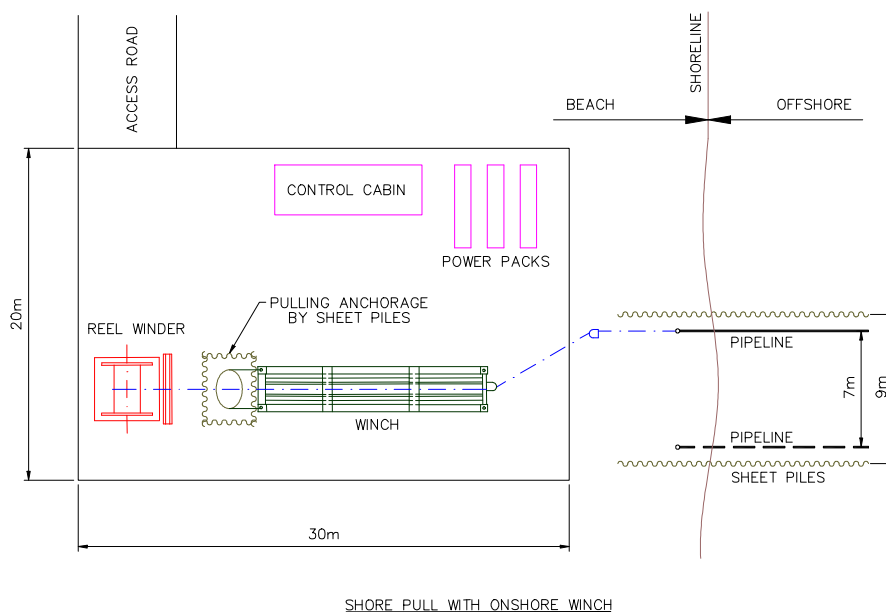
Schéma d'un treuil installé sur la plage pour amener la canalisation au rivage
